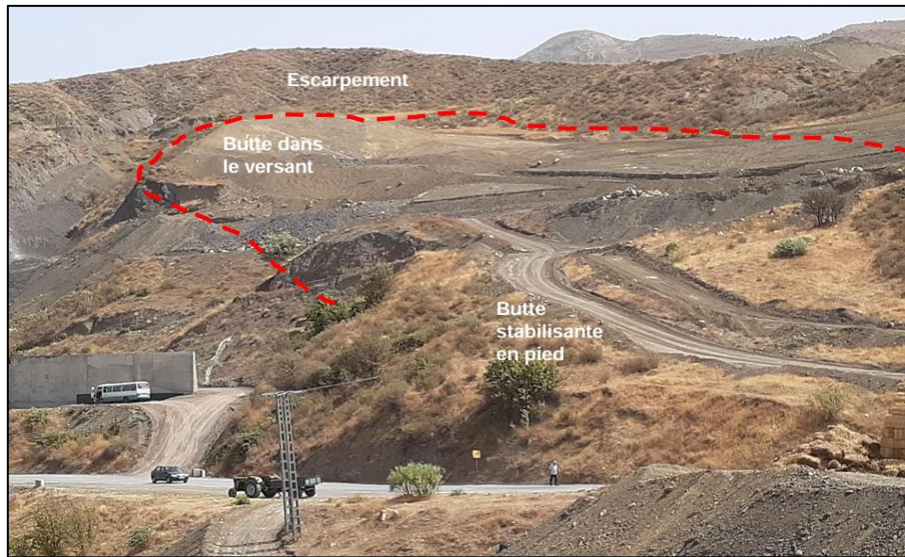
Escarpement en haut du versant, butte dans le versant et butte stabilisante en pied
